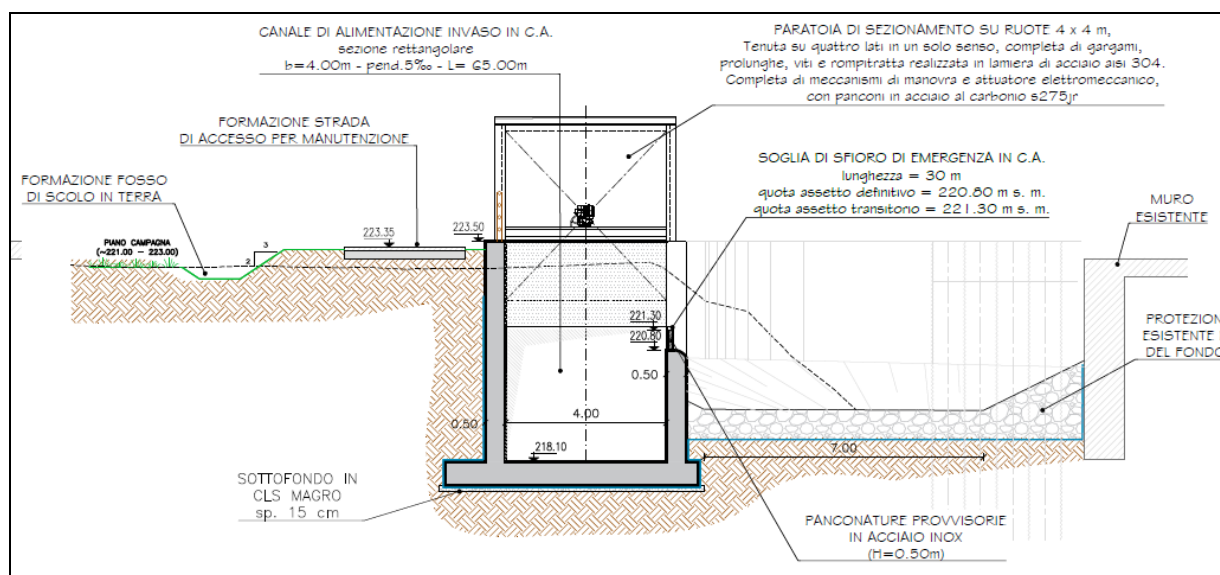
Planimetria di progetto del canale di alimentazione dell'invaso
